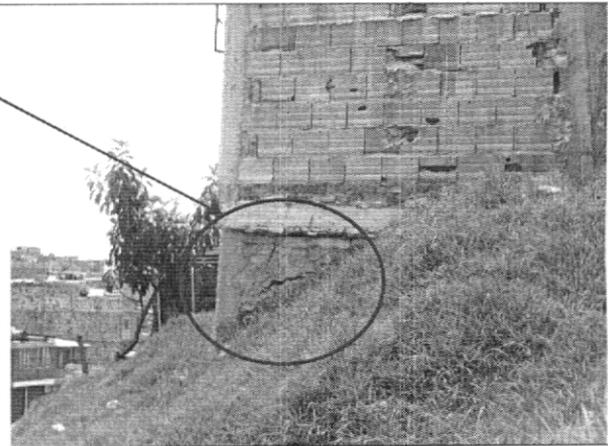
Talud de pendiente abrupta localizado en el costado sur de las viviendas 10, 11 y 12 de la Manzana A.
